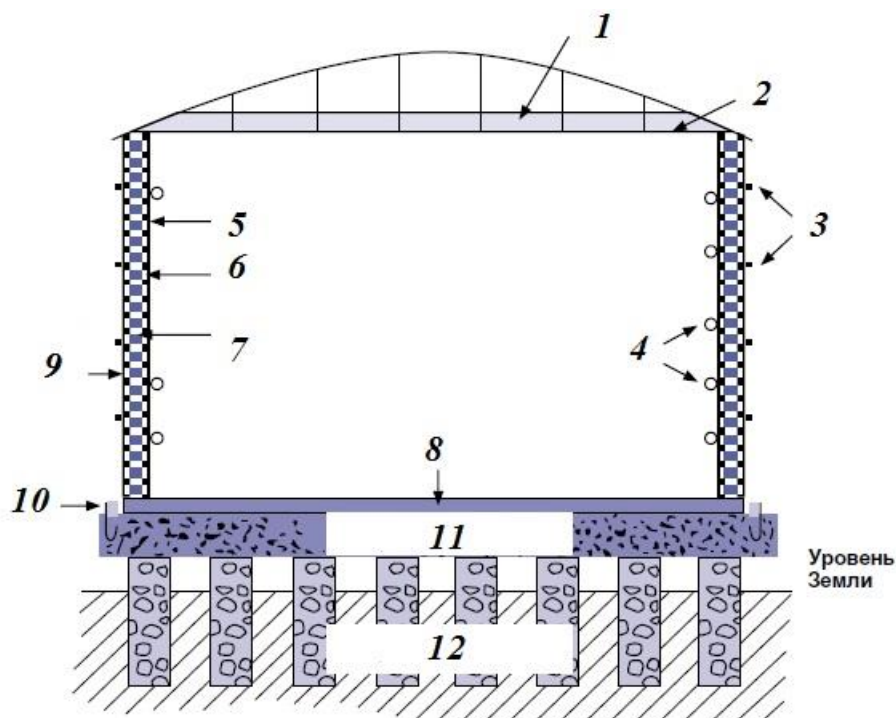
Конструкция надземного резервуара хранения СПГ.
